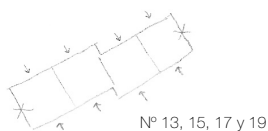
Bocetos en planta de la disposición de las construcciones situadas en la Rúa Bueu-Coia, nº 13, 15, 17 y 19 (autoría propia).
